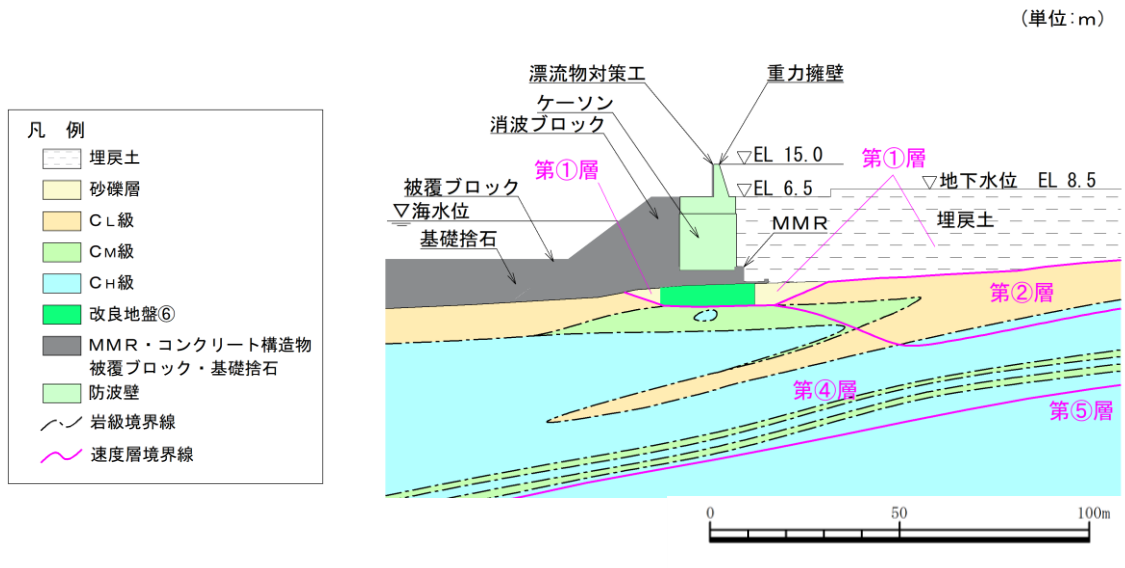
防波壁（波返重力擁壁）の横断面図（②-②断面）
